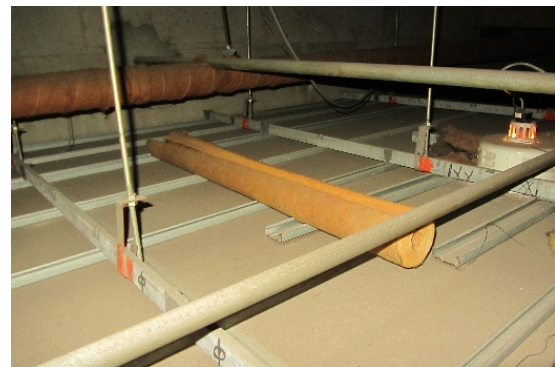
剣道場観覧席（2階）の天井裏
